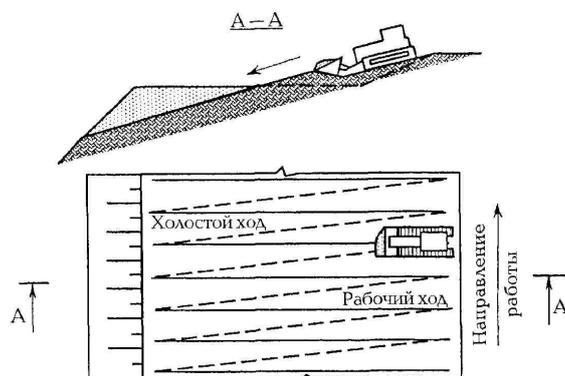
Схема разработки полков на склонах поперечными проходами бульдозера
